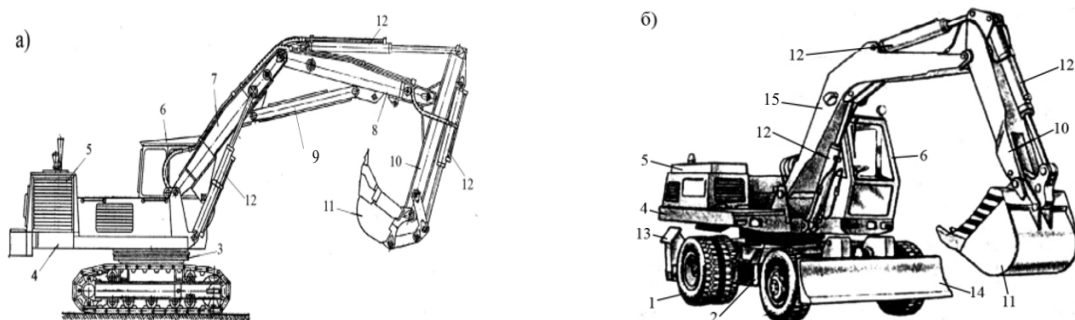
Гидравлический экскаватор «обратная лопата»: а) - конструктивная схема; б) – общий вид: 1 – задний ведущий мост с пневмоколесами; 2 – раздаточная коробка; 3 – опорно-поворотное устройство; 4 - поворотная платформа с противовесом; 5 – ДВС дизельный; 6 – кабина управления; 7 – нижняя часть шарнирно-рычажной составной стрелы; 8 – верхняя удлиняющая часть стрелы; 9 – распорка; 10 – рукоять; 11 – ковш с шарнирно-рычажным креплением к рукояти; 12 – гидроцилиндры двухстороннего действия для управления рабочим оборудованием; 13 - выносные опоры (аутригеры) со стороны разработки грунта; 14 – отвал; 15 - моноблочная сварная стрела
